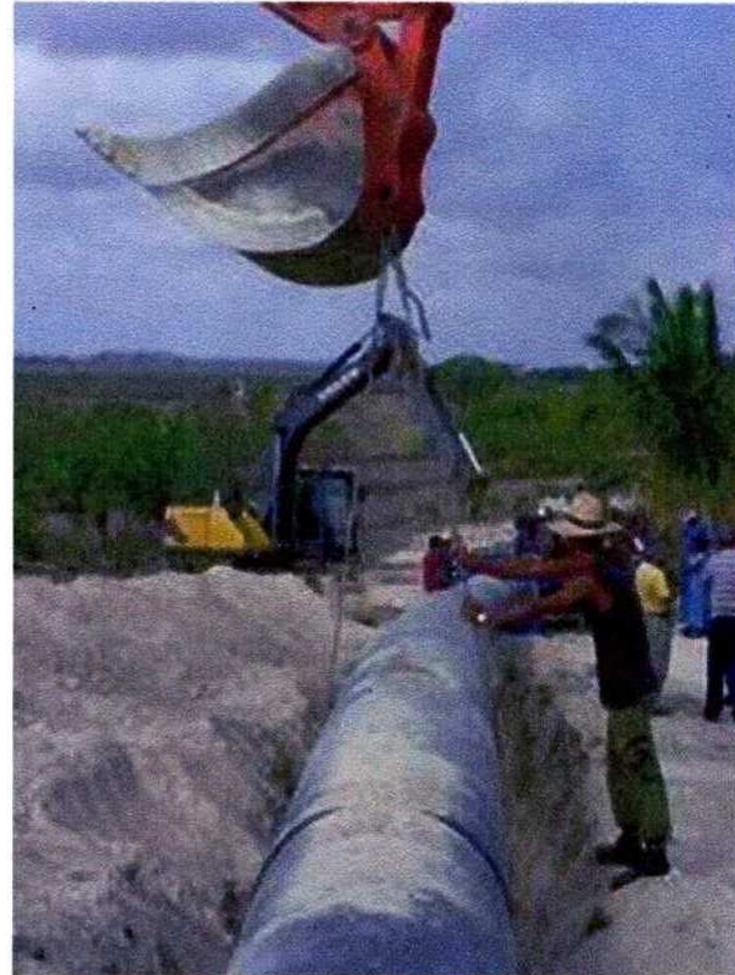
LAS OBRAS HIDRÁULICAS ES UN PROYECTO DE LA INGENIERÍA MODERNA QUE REQUIERE EL TRABAJO DE MUCHOS INGENIEROS
